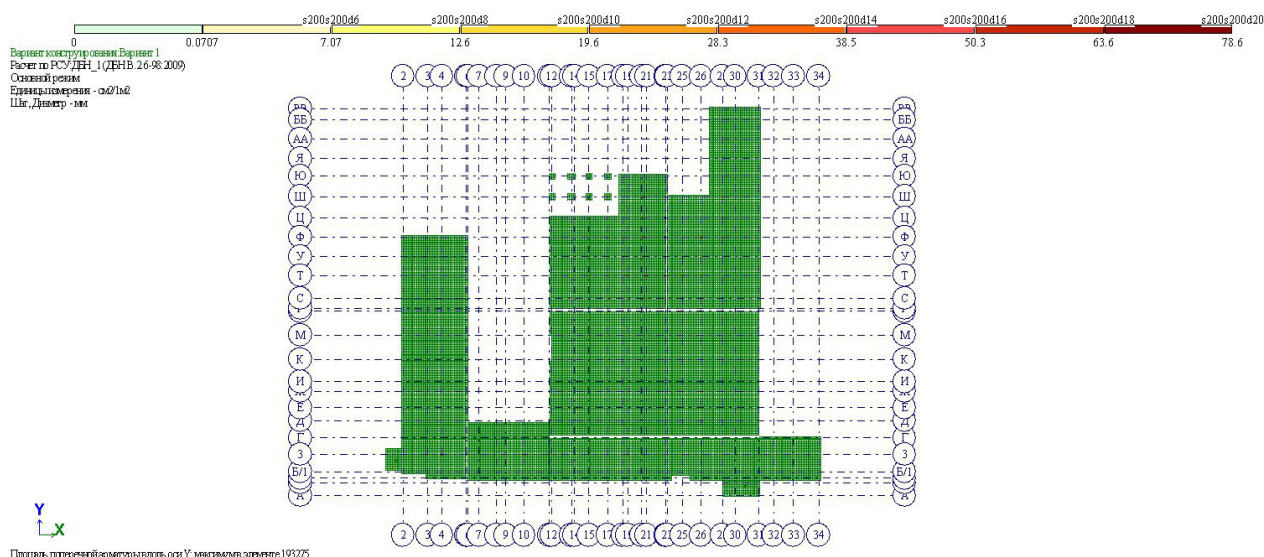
Площа поперечної арматури вздовж осі Y
